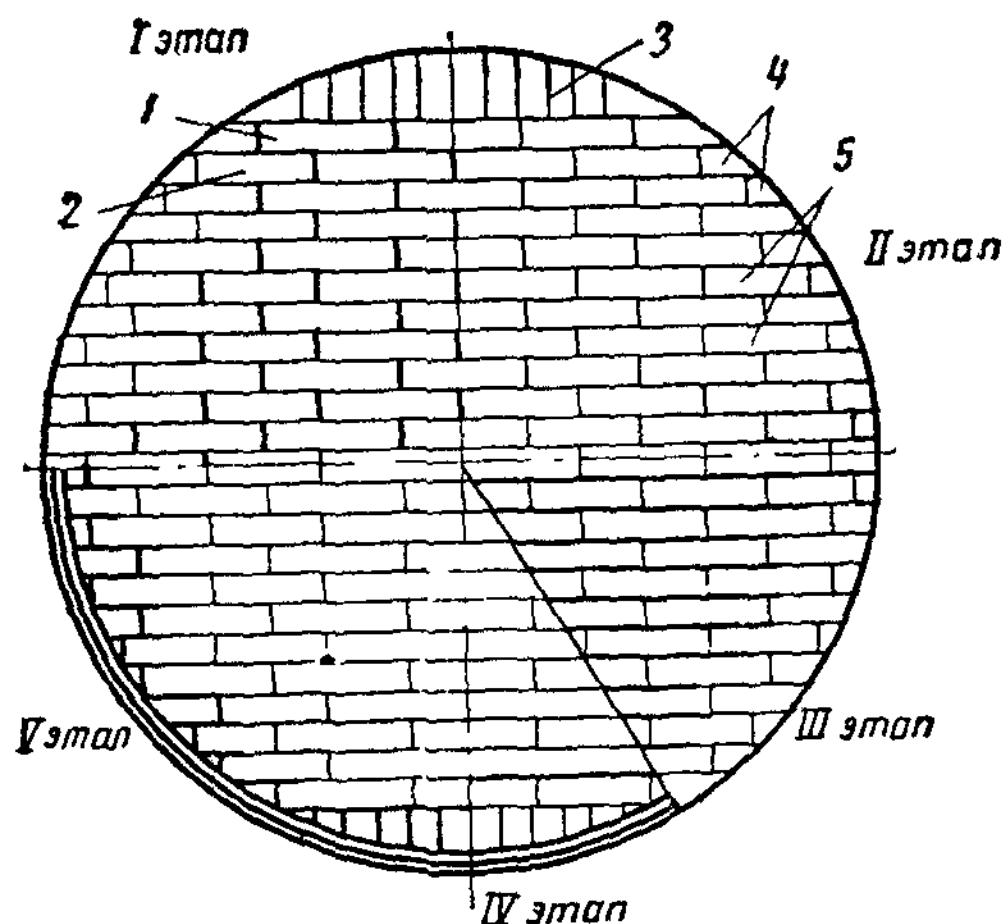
Последовательность сварки деталей днища и нижнего пояса корпуса с днищем
